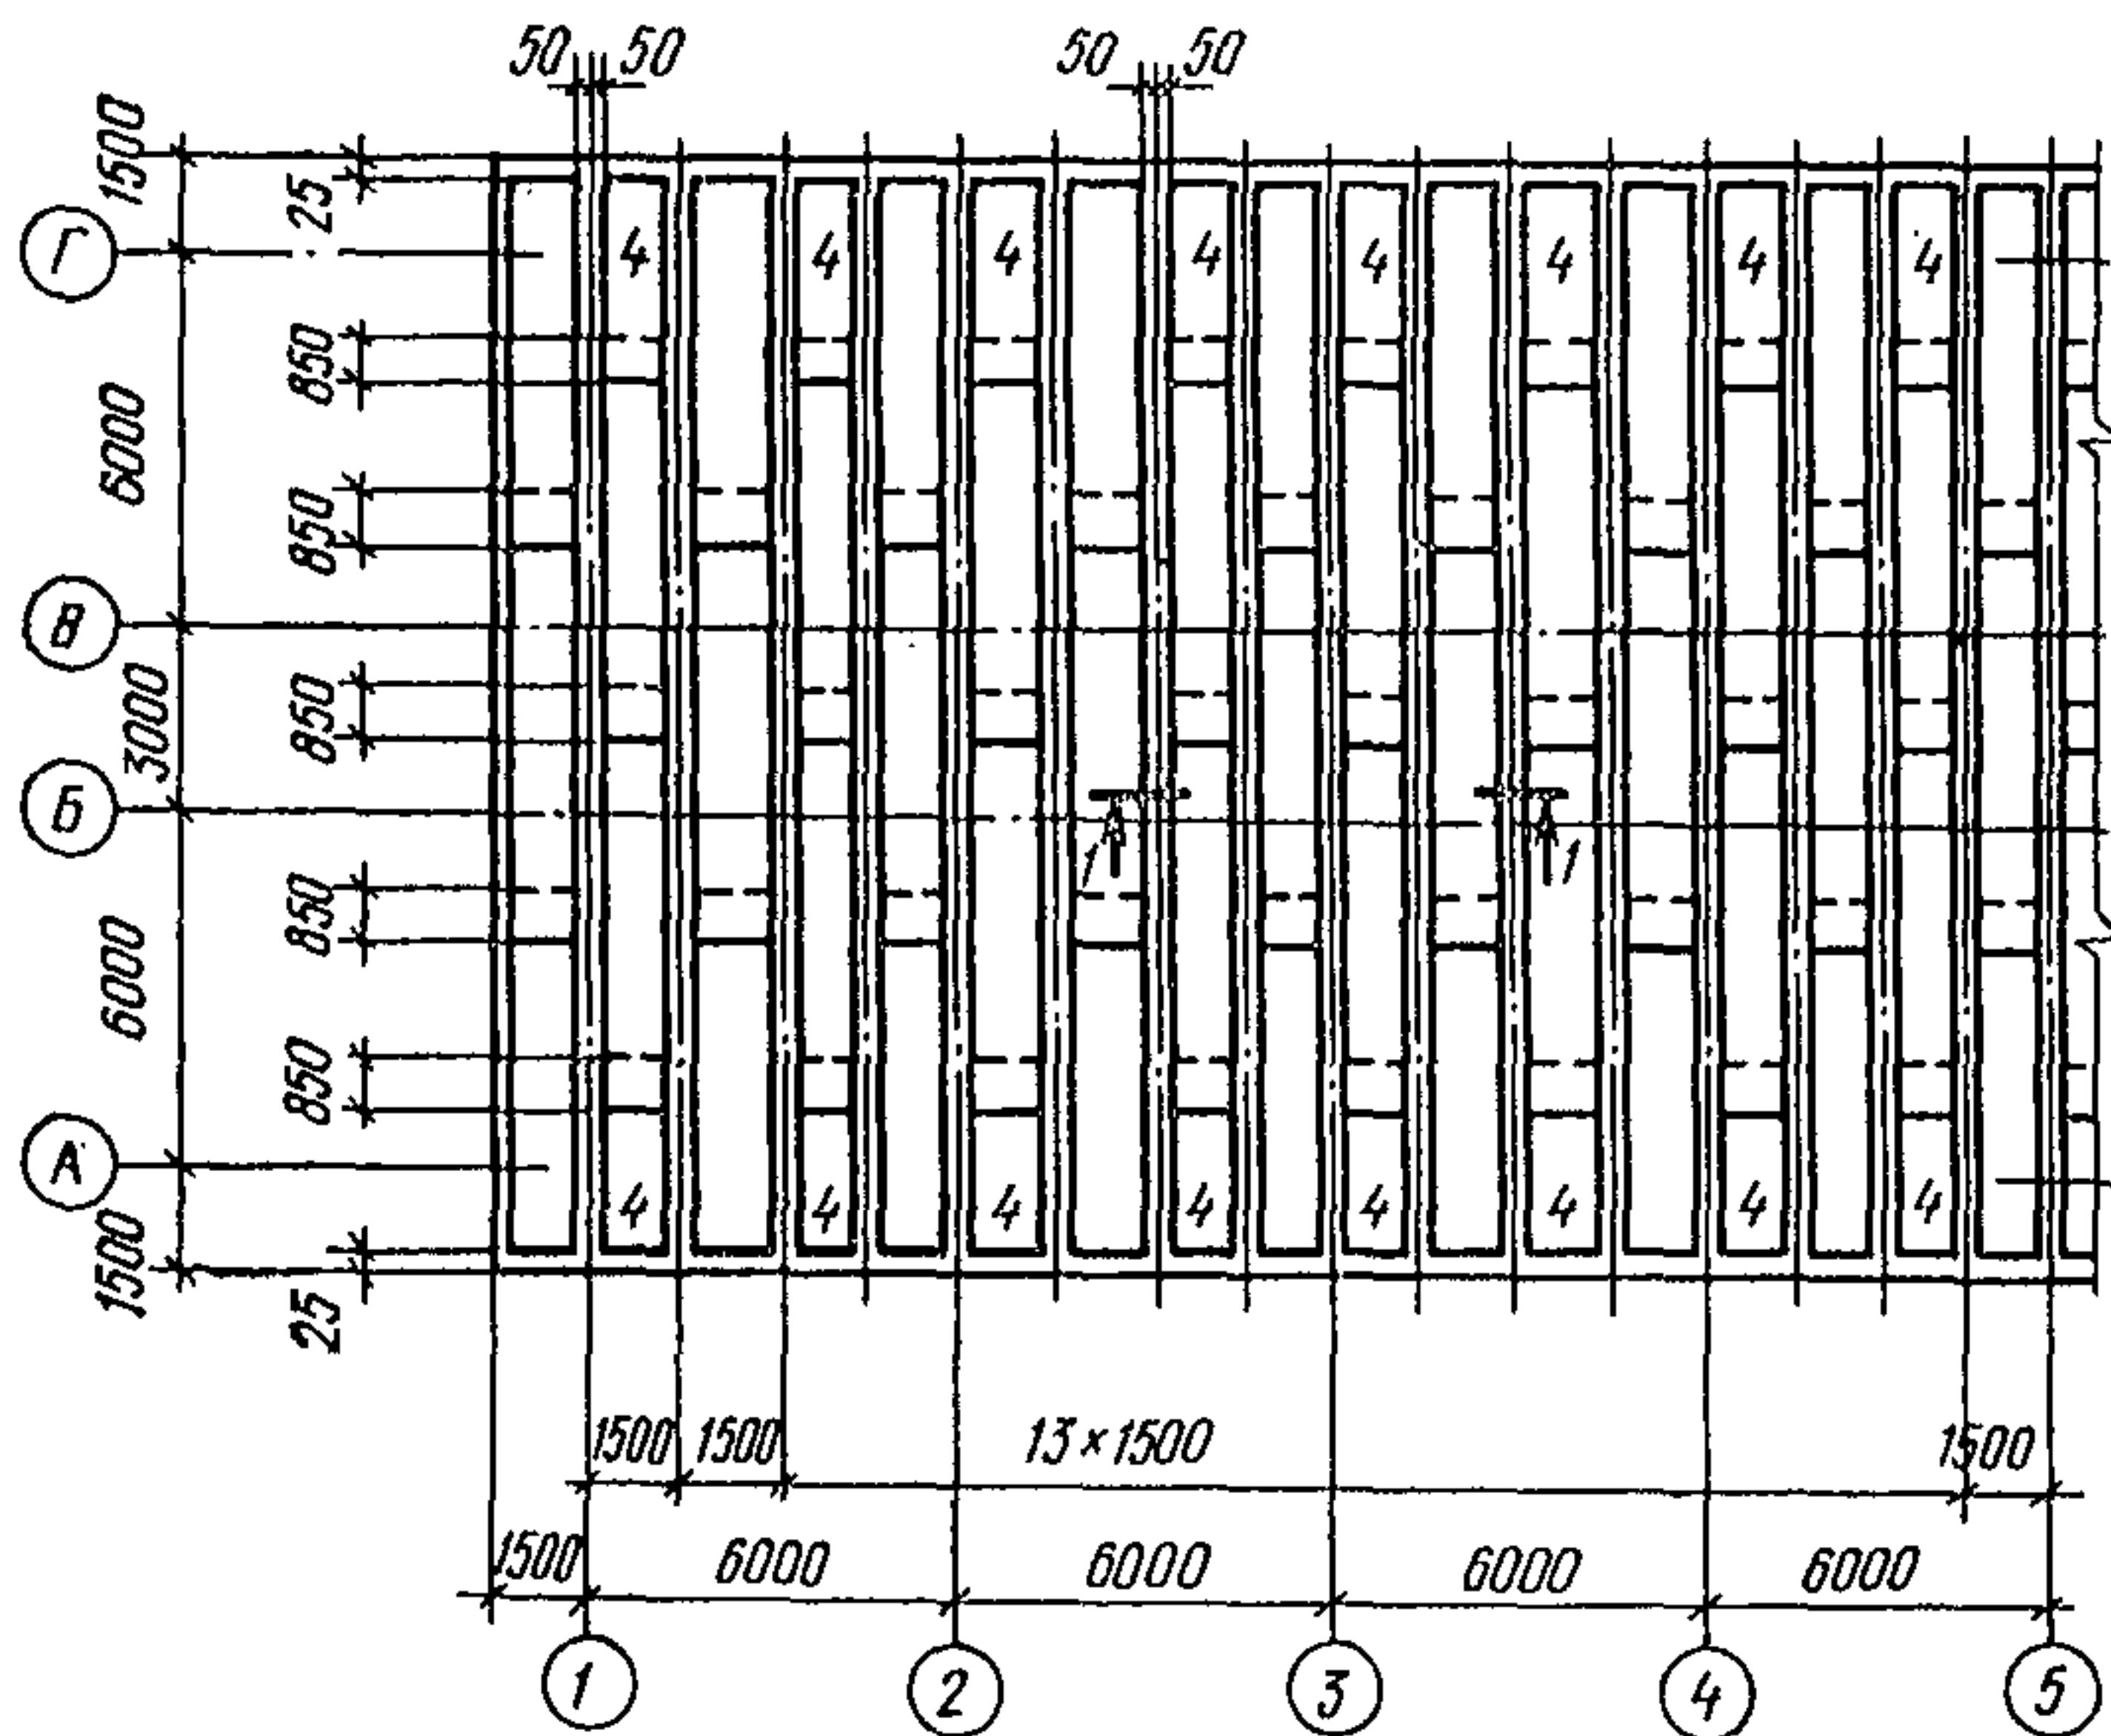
План раскладки унифицированных сеток второго слоя верхней зоны (нижние сетки)
